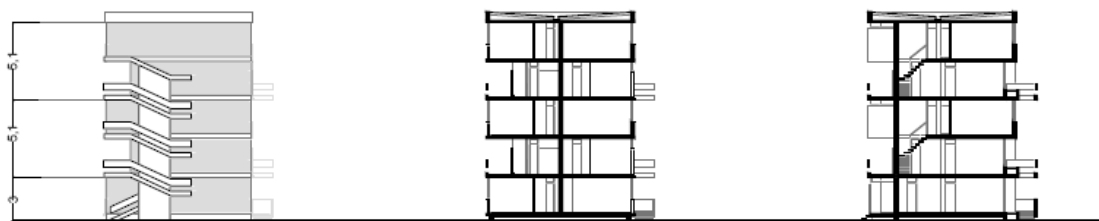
Elevaciones del bloque dúplex de Villa Frei. Fuente: Expediente de declaratoria de Zona Típica, planos elaborados por José Becerra (2014)
